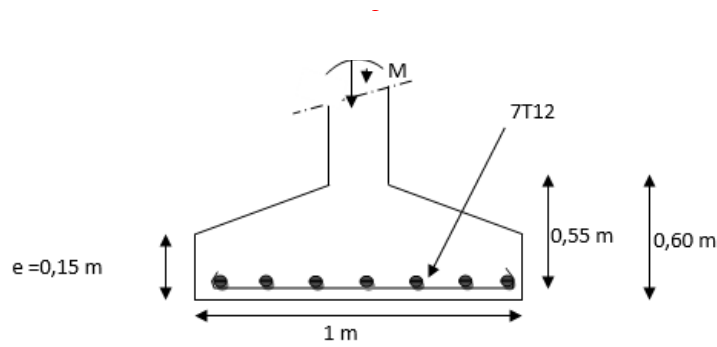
5 : Ferrailage de la semelle intermédiaire
